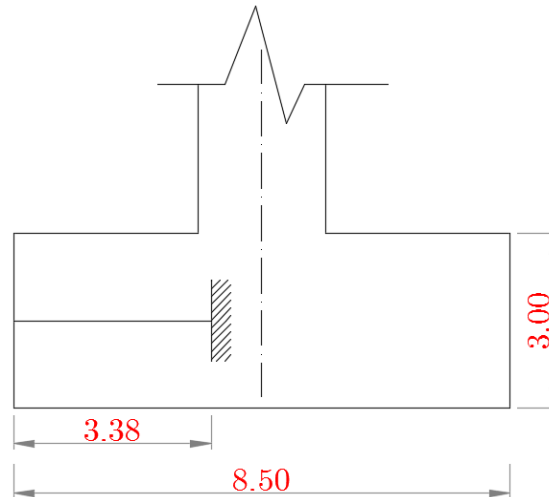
Modelo de cálculo para dimensionamento das armaduras na face superior das sapatas
